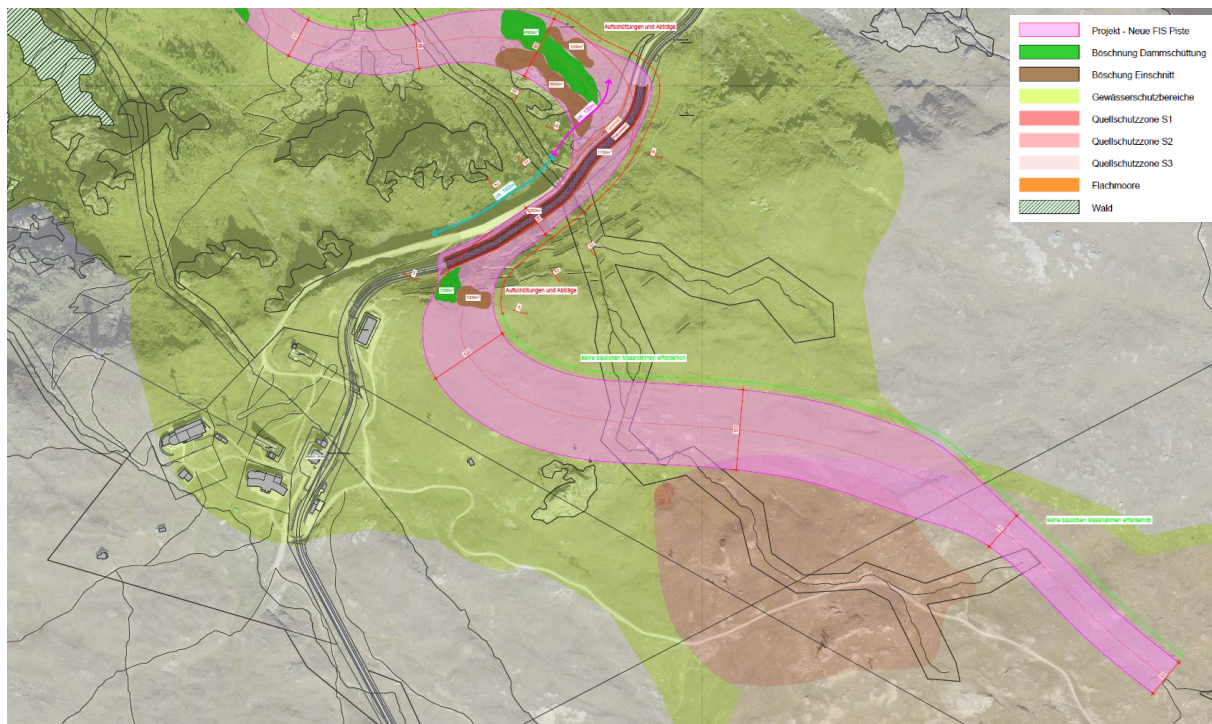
Planausschnitt technischer Plan Abschnitt 1 (LABAG)
